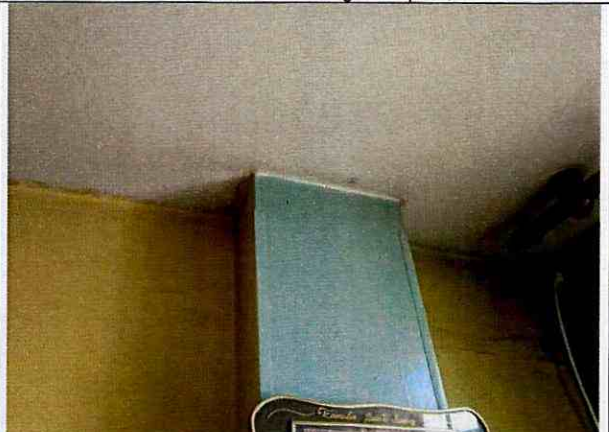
Detalle de la grieta del muro de segundo nivel.
